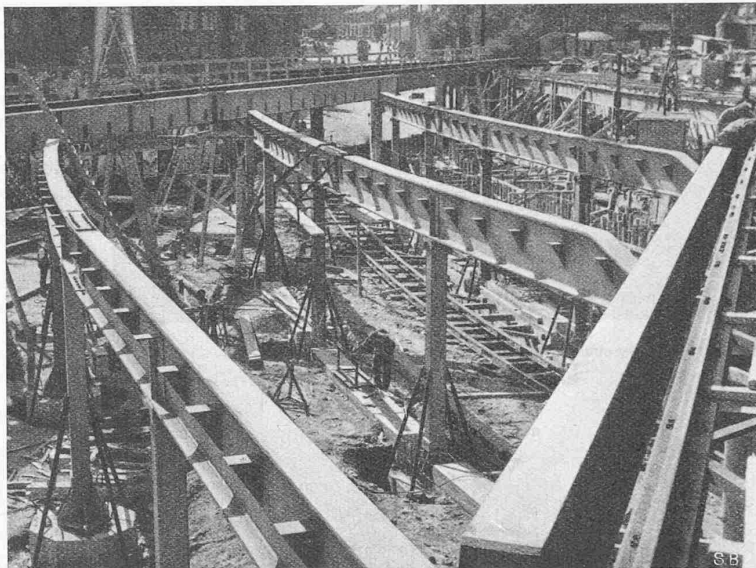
Montage des Stahlbaues von Los 5b (Neubrückstrassen-Unterführung)
